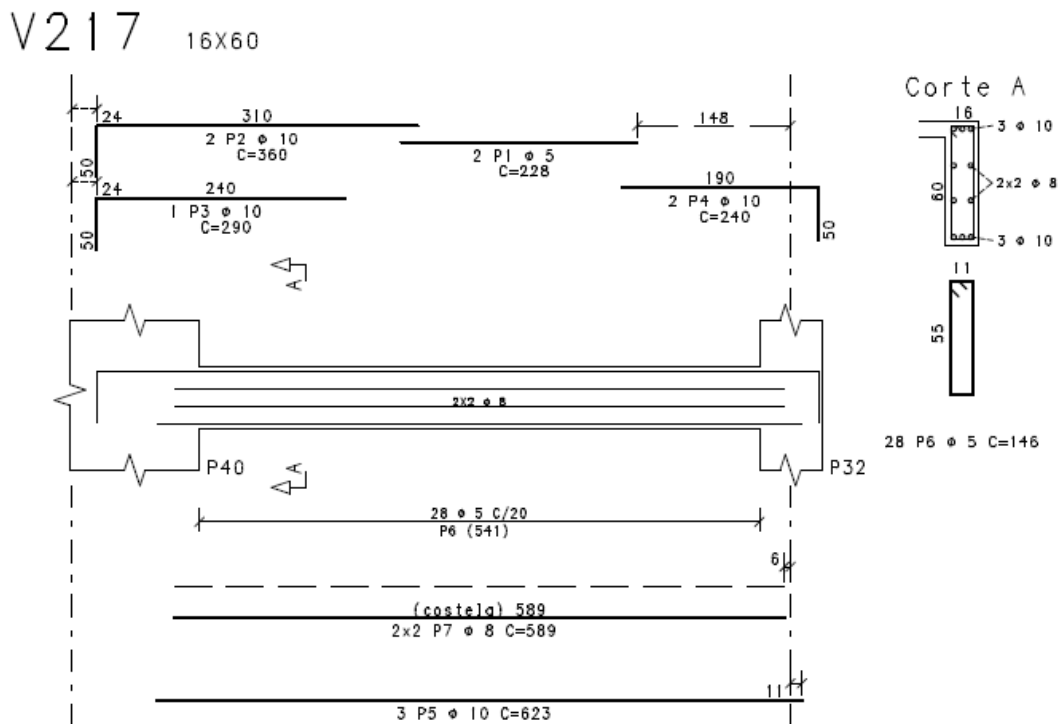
47 - Detalhamento final da viga V217 após as edições realizadas..
